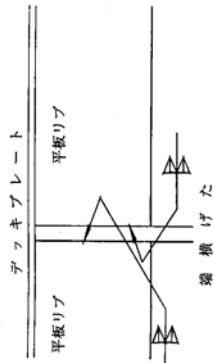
平板リブまたはバルブプレートリブと端横リブまたは端横げたの交差部構造の標準
